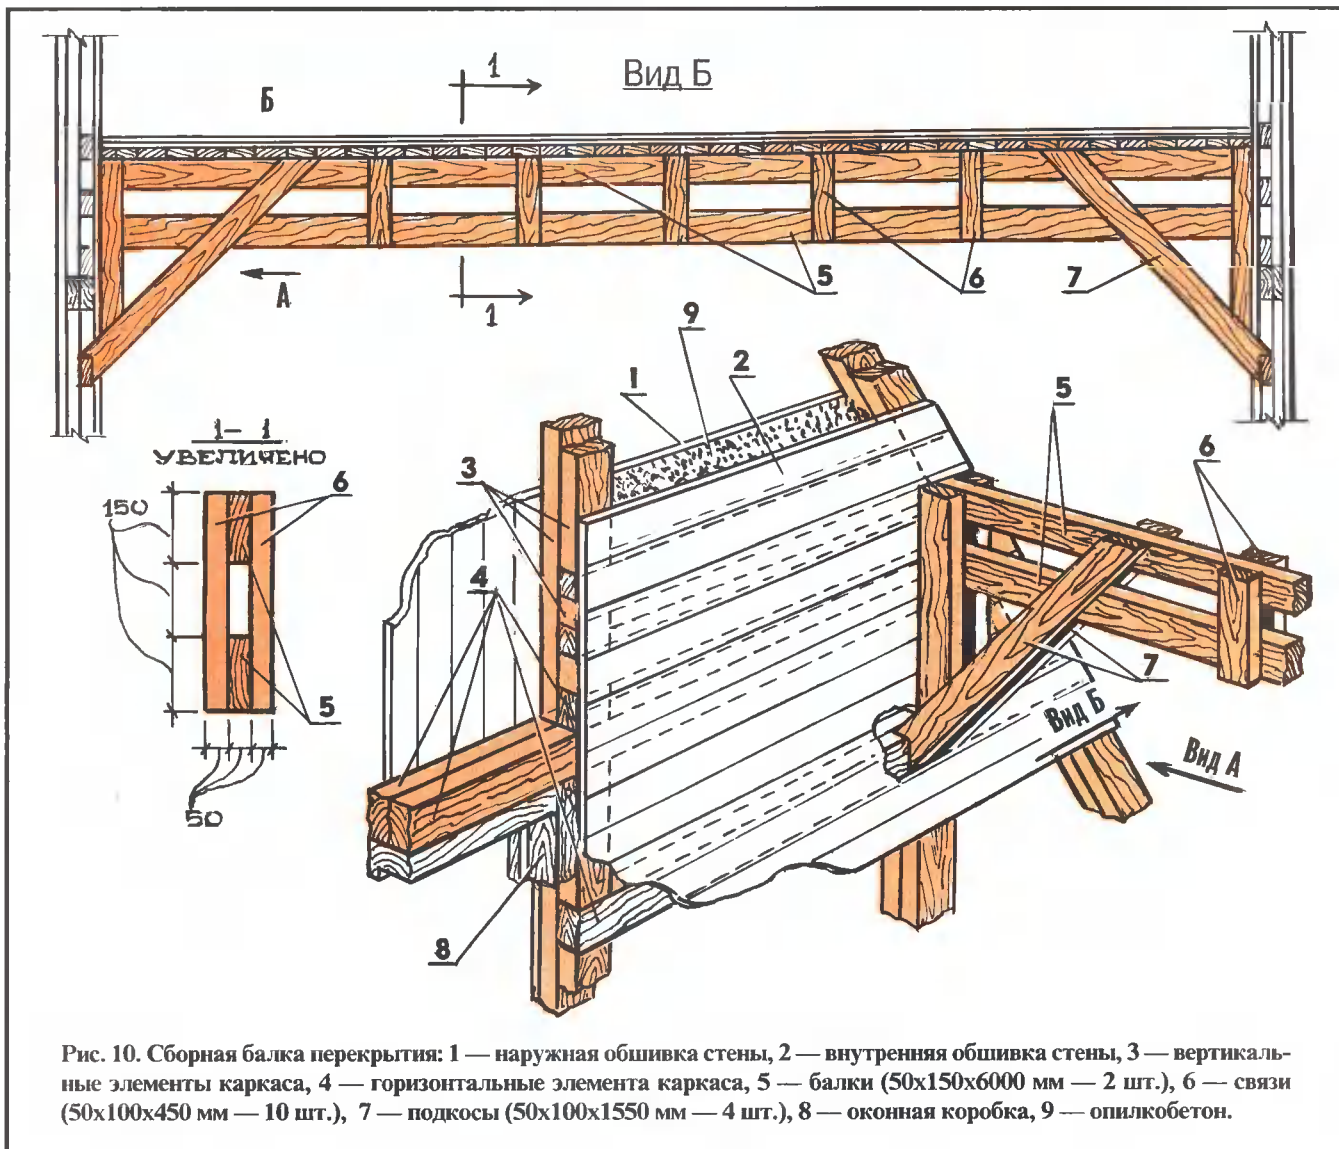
Сборная балка перекрытия: 1 — наружная обшивка стены, 2 — внутренняя обшивка стены, 3 — вертикальные элементы каркаса, 4 — горизонтальные элемента каркаса, 5 — балки (50x150x6000 мм — 2 шт.), 6 — связи (50x100x450 мм — 10 шт.), 7 — подкосы (50x100x1550 мм — 4 шт.), 8 — оконная коробка, 9 — опилкобетон.
